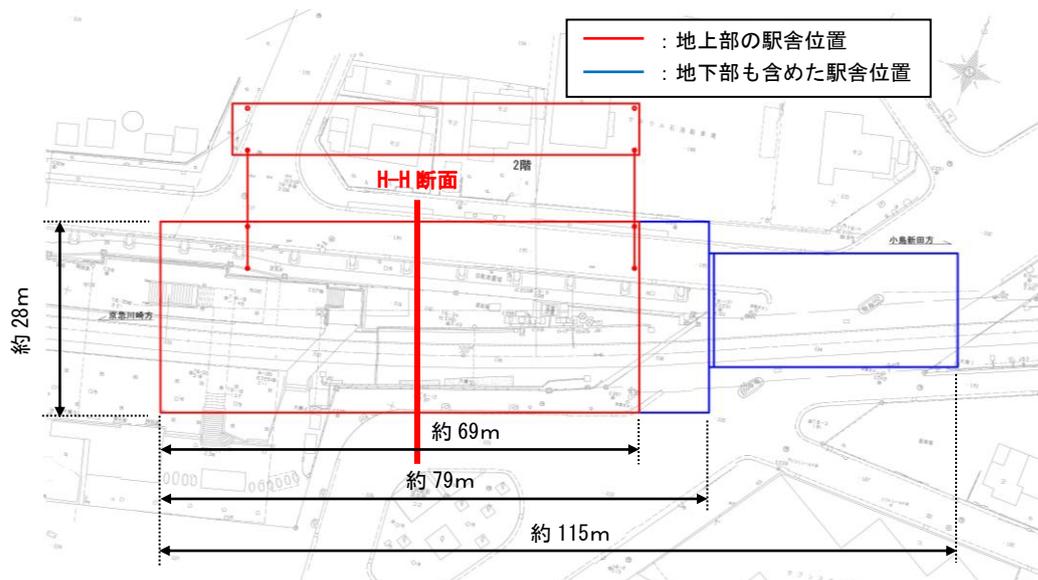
(3) 駅部平面図 (川崎大師駅部)
